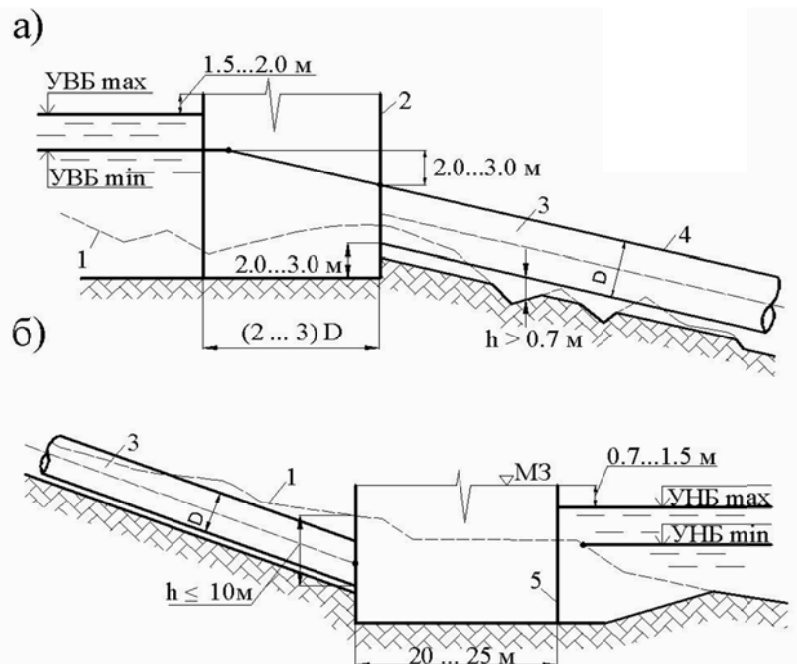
Схемы размещения водоприемника напорного бассейна и здания ГЭС: а – размещение водоприемника на трассе трубопровода; б – размещение здания ГЭС на трассе трубопровода; 1 – дневная поверхность земли; 2 – водоприемник; 3 – трубопровод; 4 – верхняя кромка трубопровода; 5 – здание ГЭС
